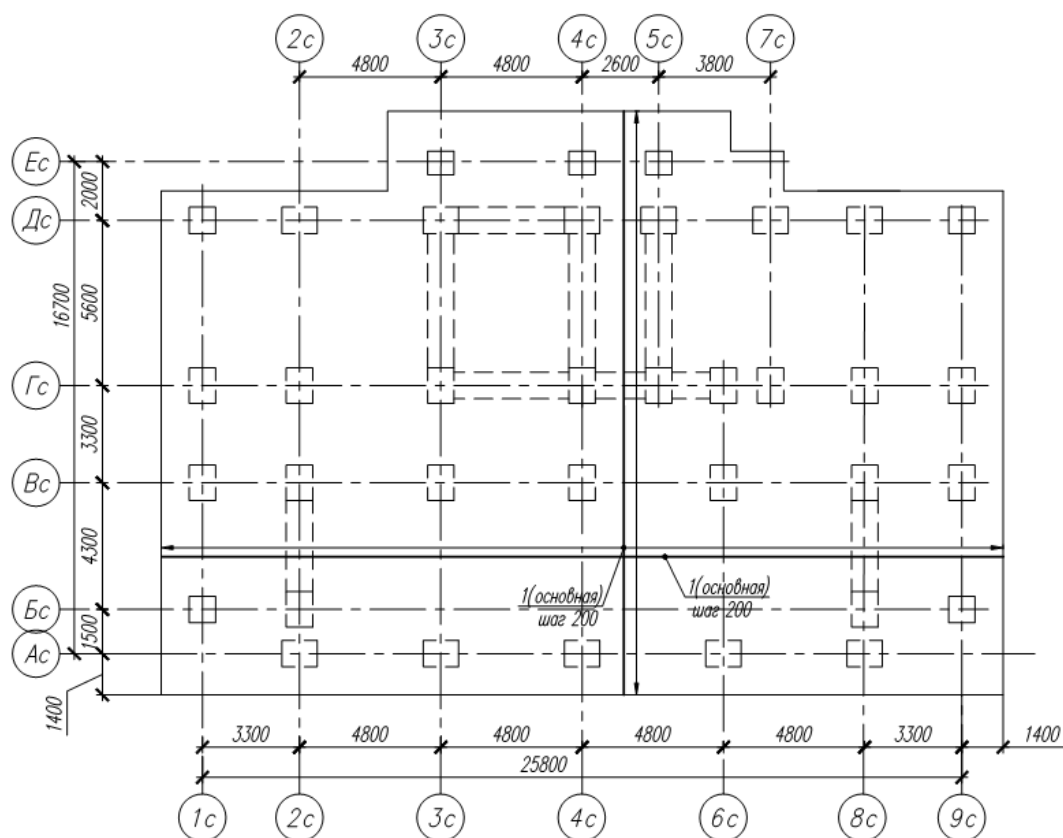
Схема расположения верхней арматуры ф/б фундамента
